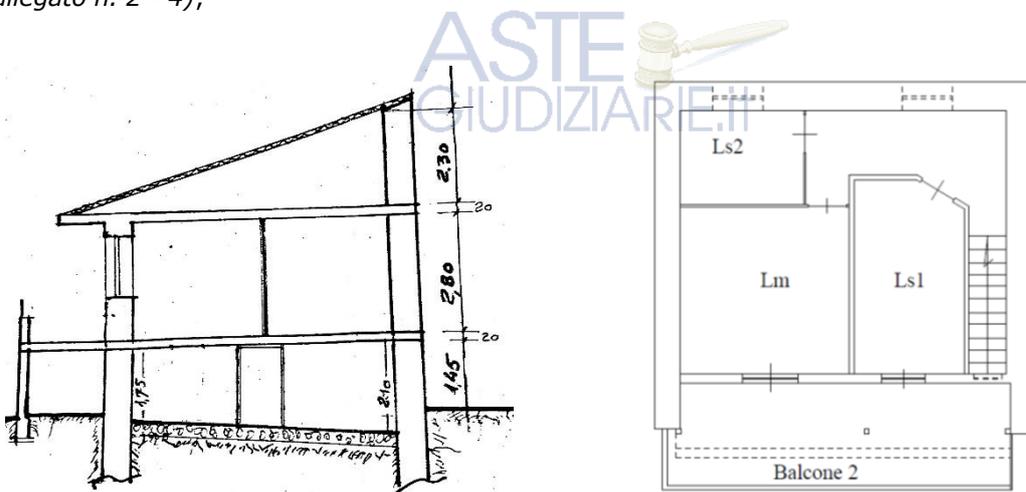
sezione nell'allegato grafico del Permesso a Costruire del piano primo e pianta dei beni all'attualità.
